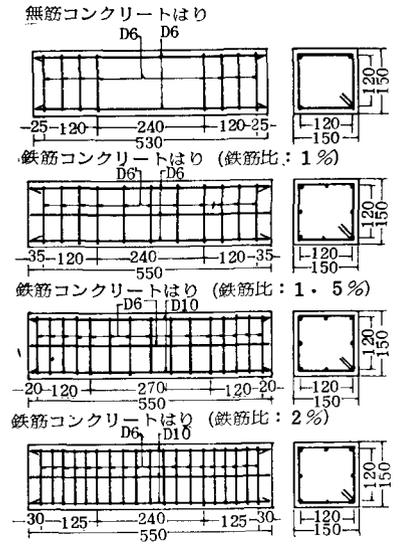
ねじり疲労試験用供試はりの配筋図 (mm)
